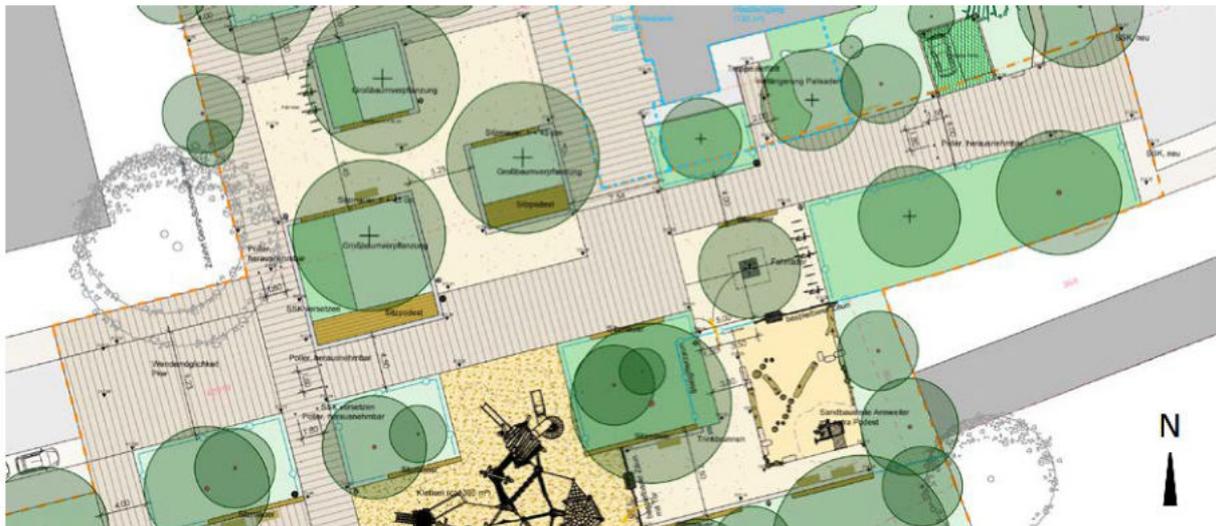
Lageplanausschnitt Entwurf Frankenstraße
